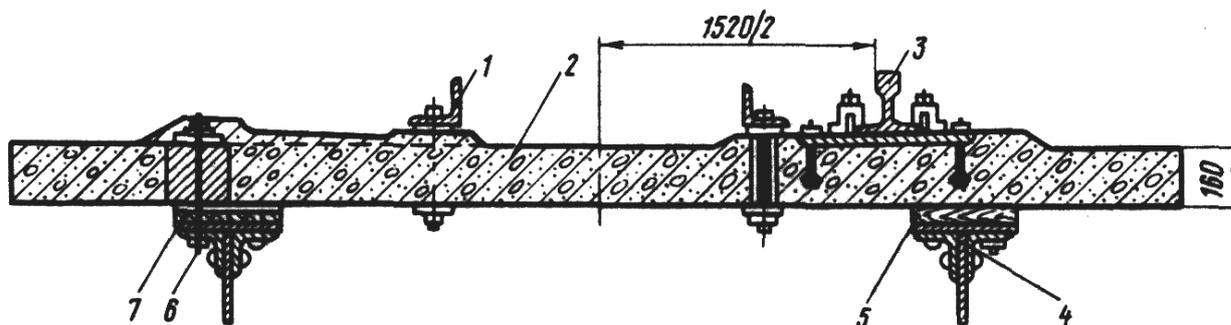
Конструкция безбалластного мостового полотна на железобетонных плитах: 1 – контруголок 160 x I60 x 16; 2 – плита; 3 – путевой рельс; 4 – опорная деревянная прокладка; 5 – продольная балка; 6 – шпилька; 7 – арматура прокладного слоя
